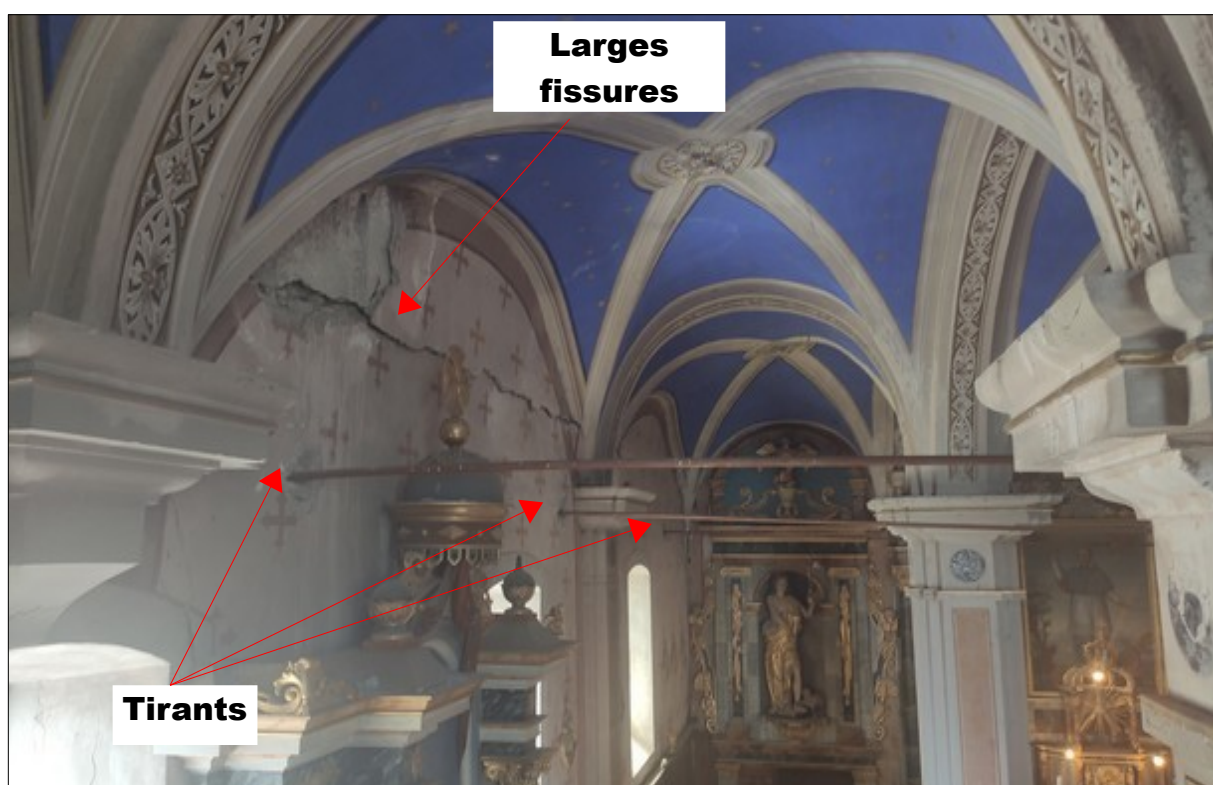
Tirants et fissurations sur le mur Sud de l'église
